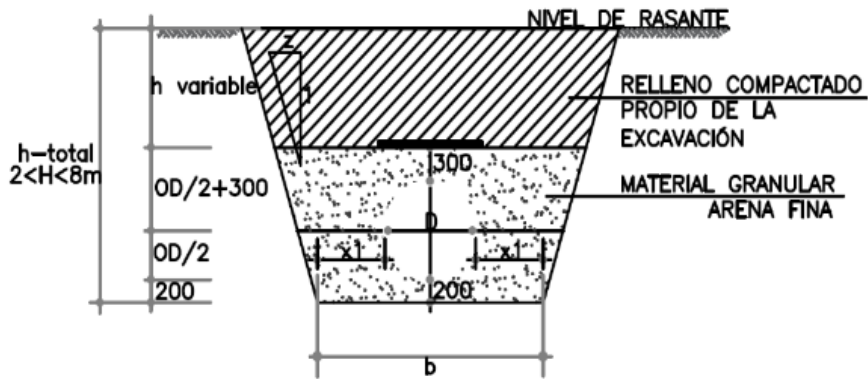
Sección típica de la zanja. Fuente: (Yong, 2014).
